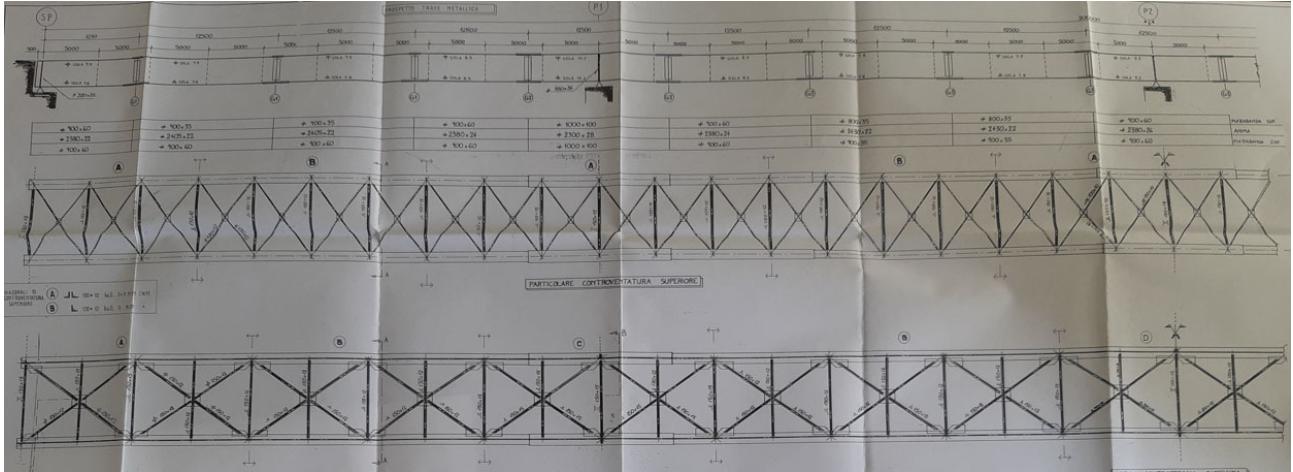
Stralcio progetto costruttivo travata in carpenteria metallica
